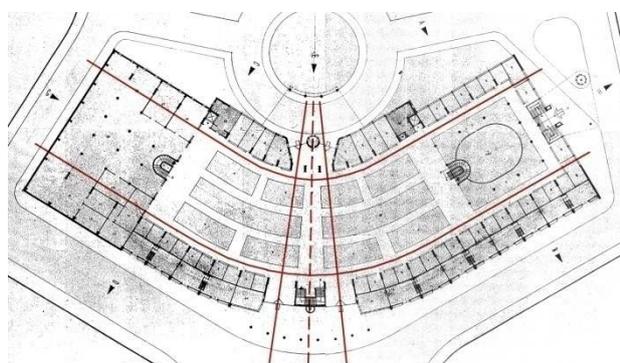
Planta esquemática (Piso 2): eixos estruturantes
